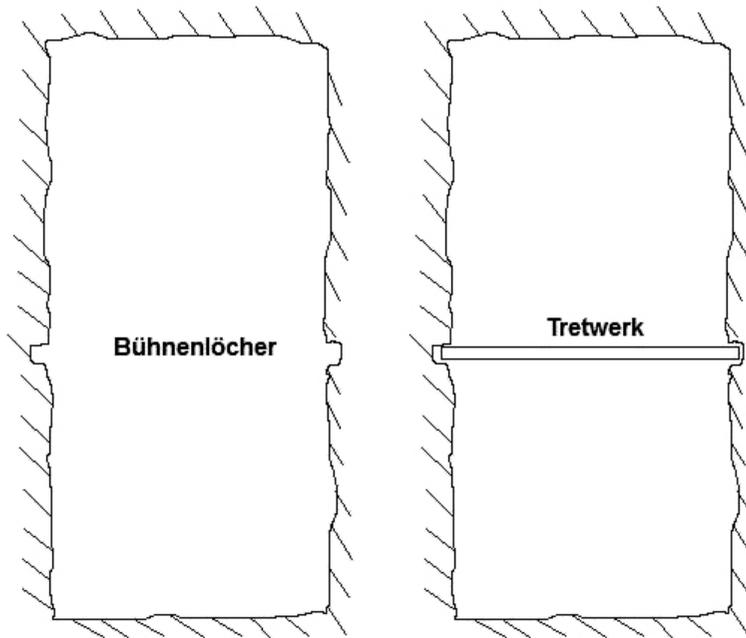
Handgeschrämte Wasserlösungsstollen.
